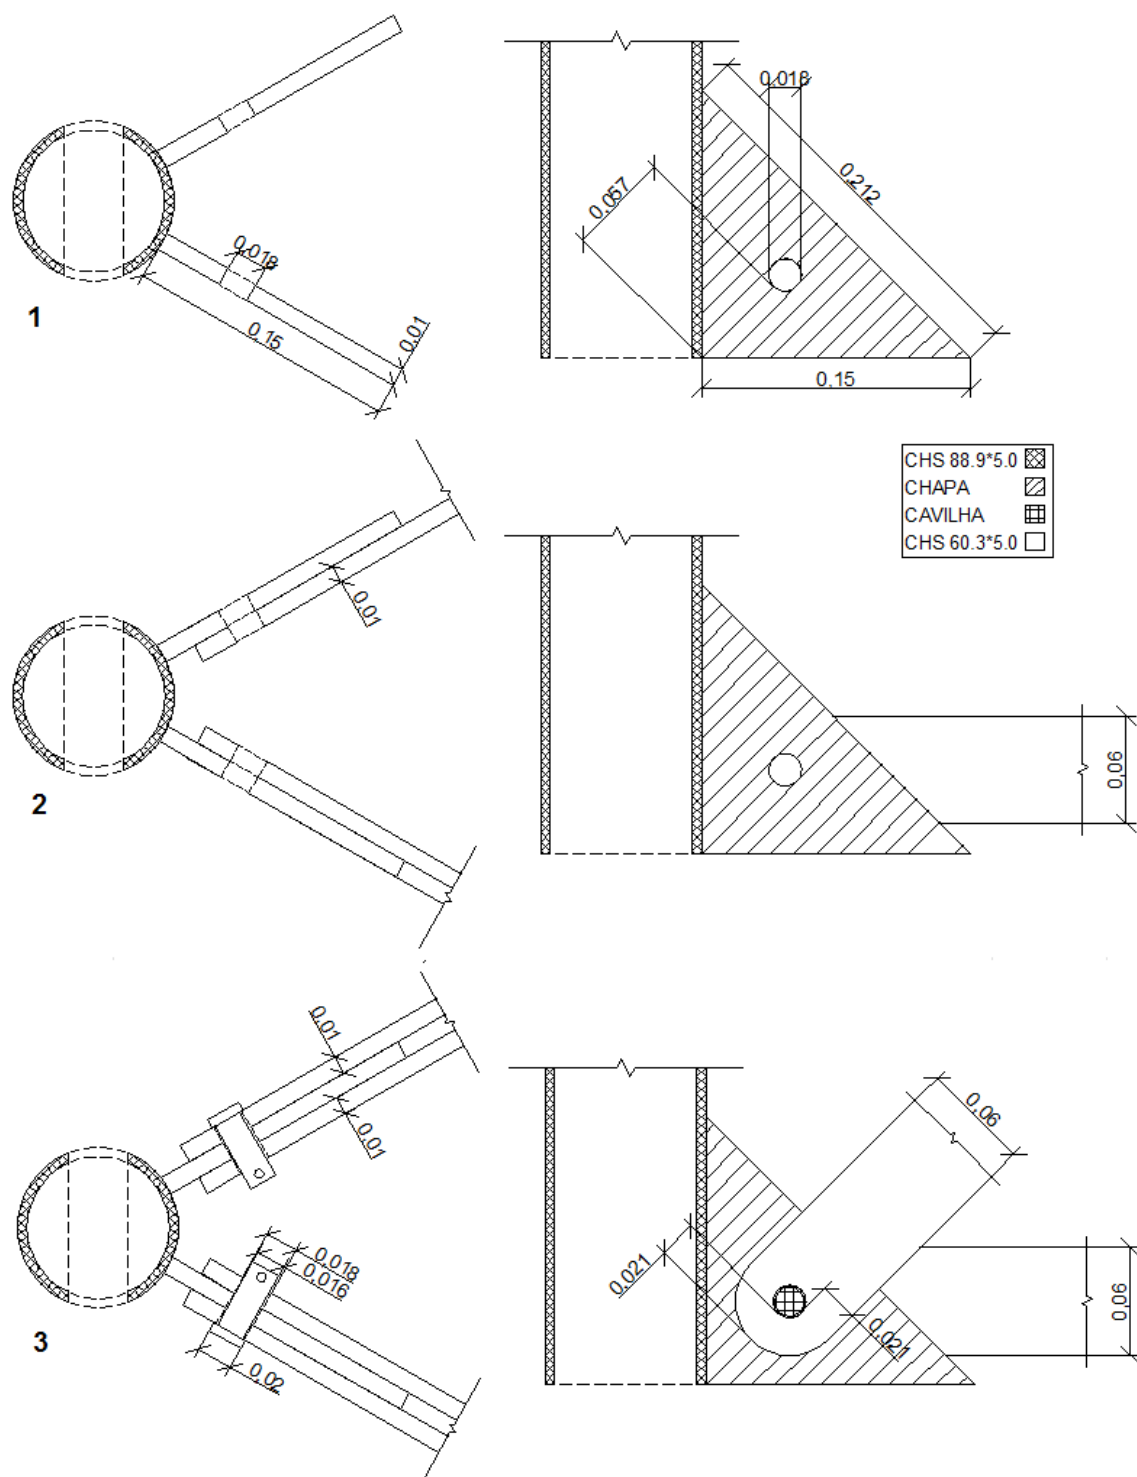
Ligação dos elementos horizontais e contraventamentos [m]
